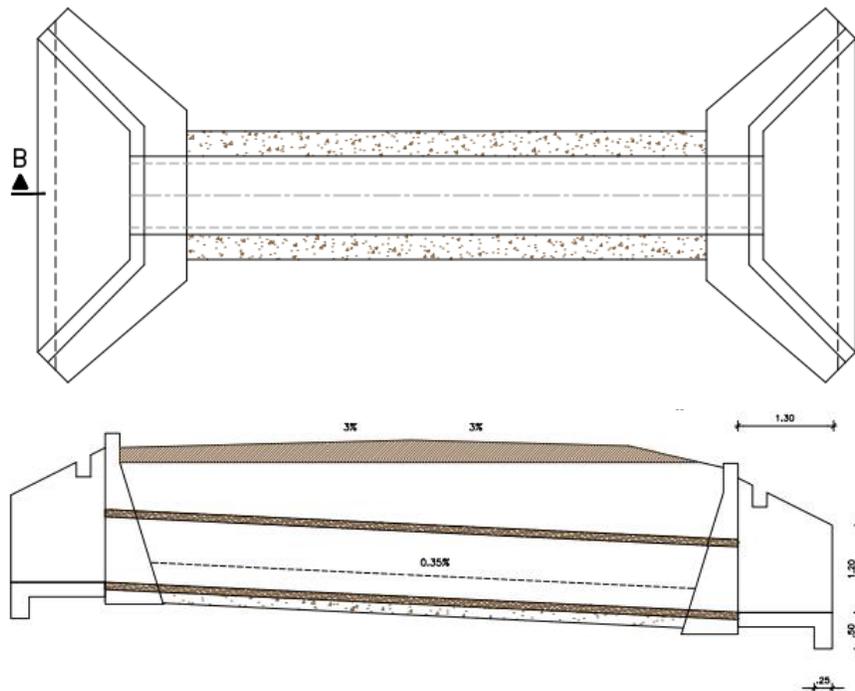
Esquema tipo de implantación alcantarillas Box Culvert – Línea de Transmisión
